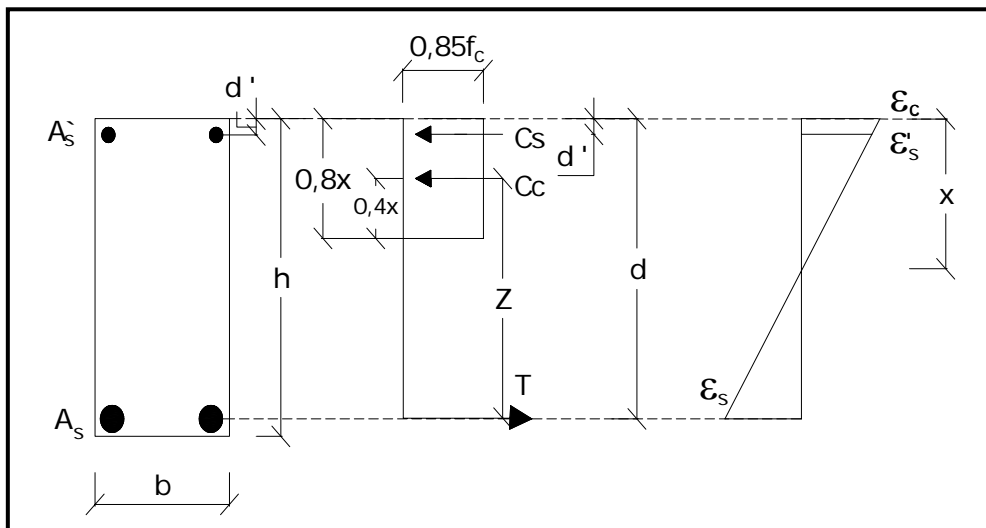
Diagrama retangular simplificado de tensões e diagrama de deformações da seção da viga.
